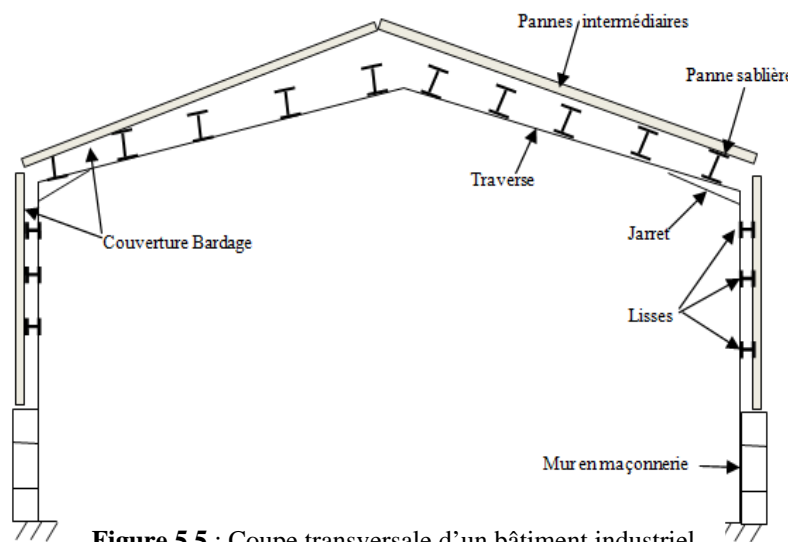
Coupe transversale d'un bâtiment industriel
